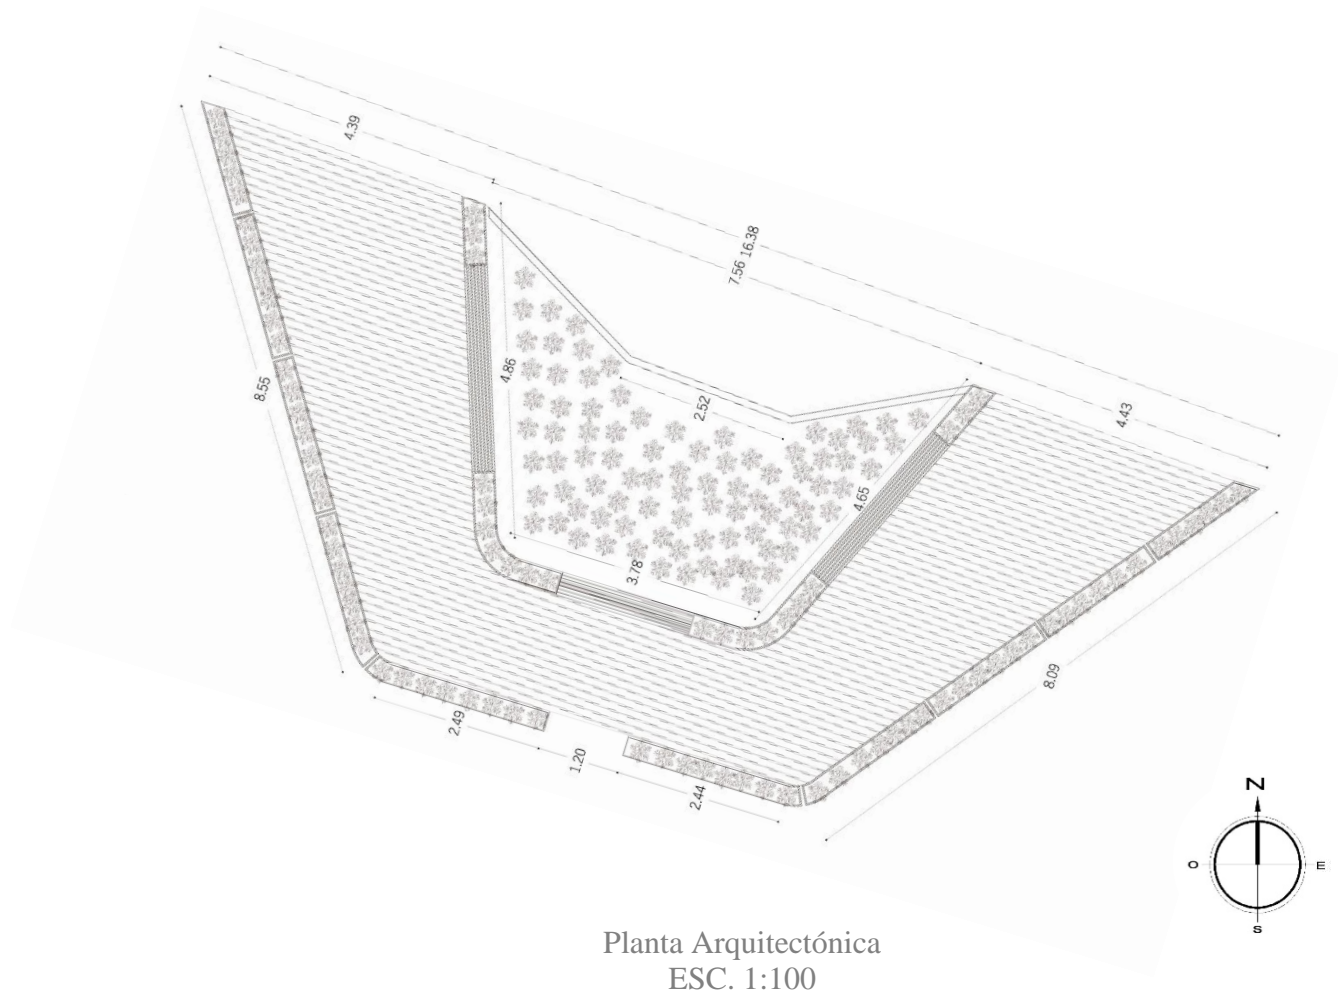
Planta arquitectónica de muelle. Fuente: grupo de investigación.
